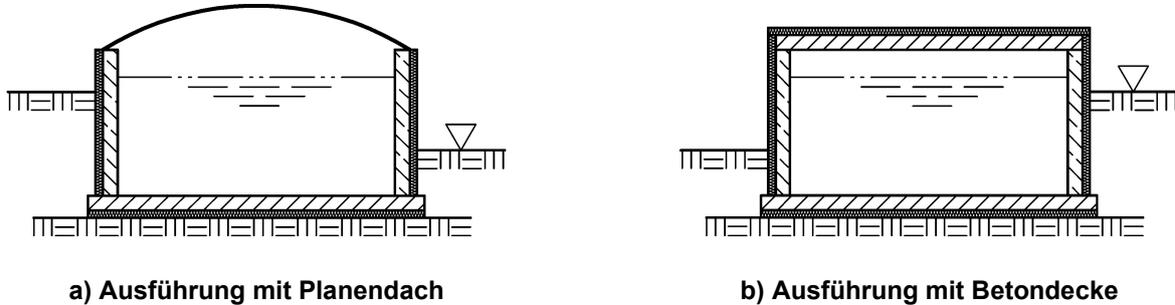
Gedeckte außen gedämmte Biogasbehälter
